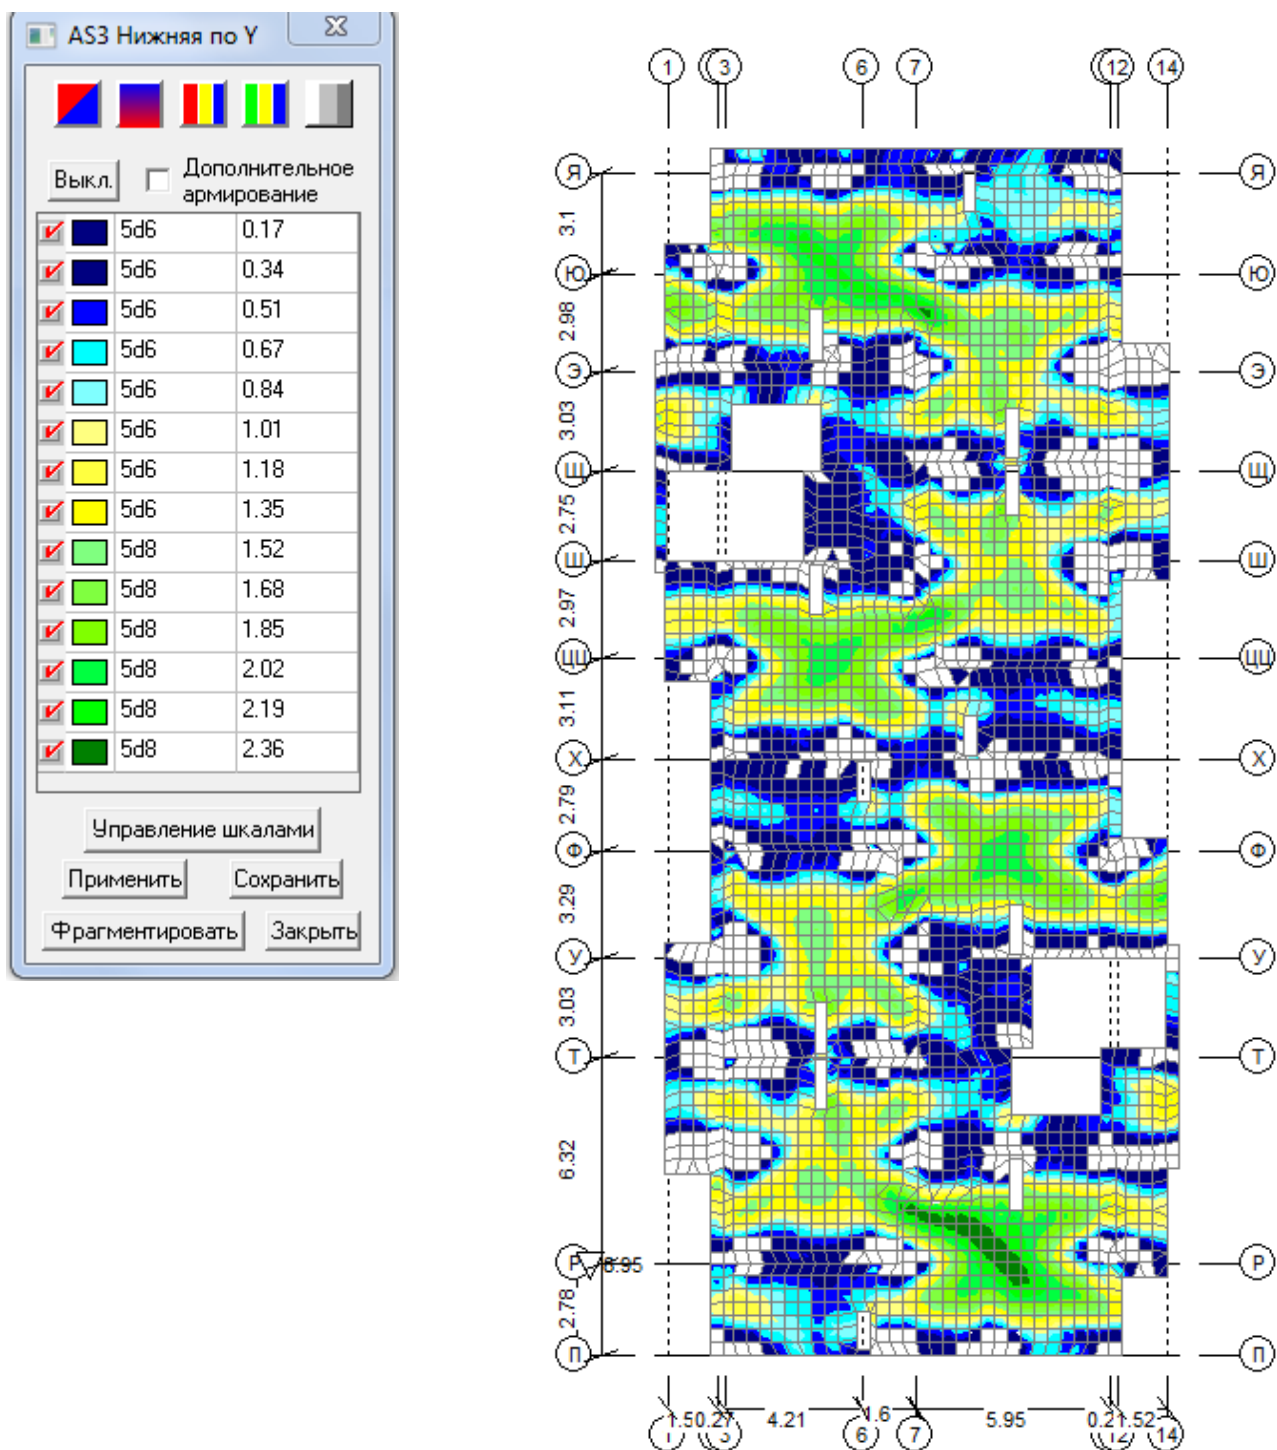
Армирование нижней плиты перекрытия по Y
